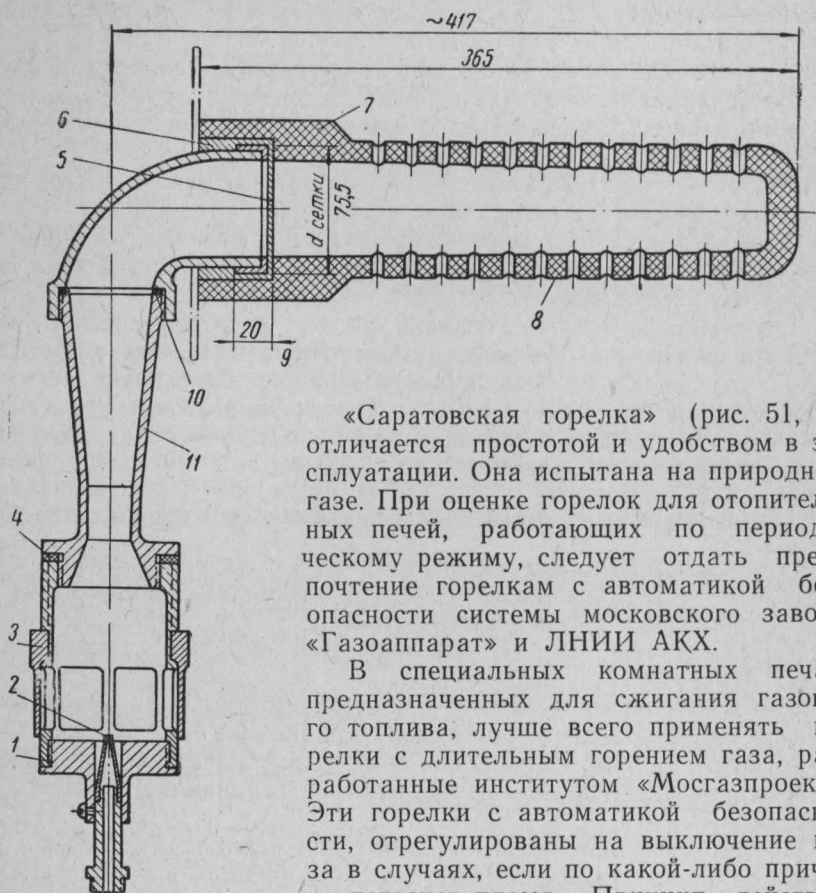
Беспламенная горелка АКХ для изразцово-каркасной печи: 1 — гайка; 2 — сопло; 3 — муфта для регулирования подачи воздуха; 4 — подкладка; 5 — предохранительная сетка; 6 — асбест; 7 — асбестовое кольцо; 8 — головка горелки; 9 — загиб сетки; 10 — медно-асбестовая подкладка; 11 — диффузор.
